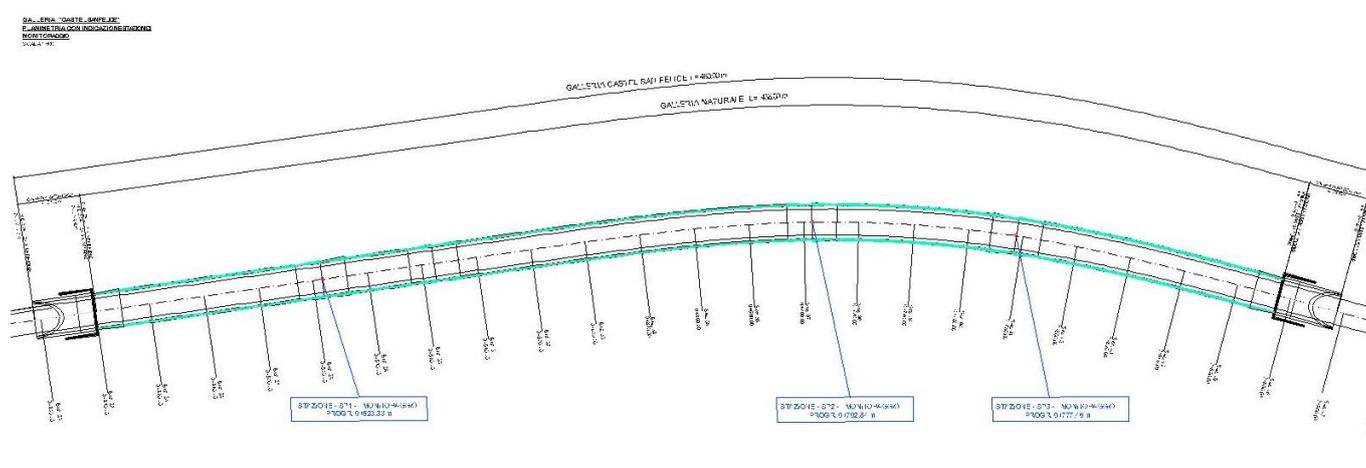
Planimetria con ubicazione sezioni di monitoraggio
